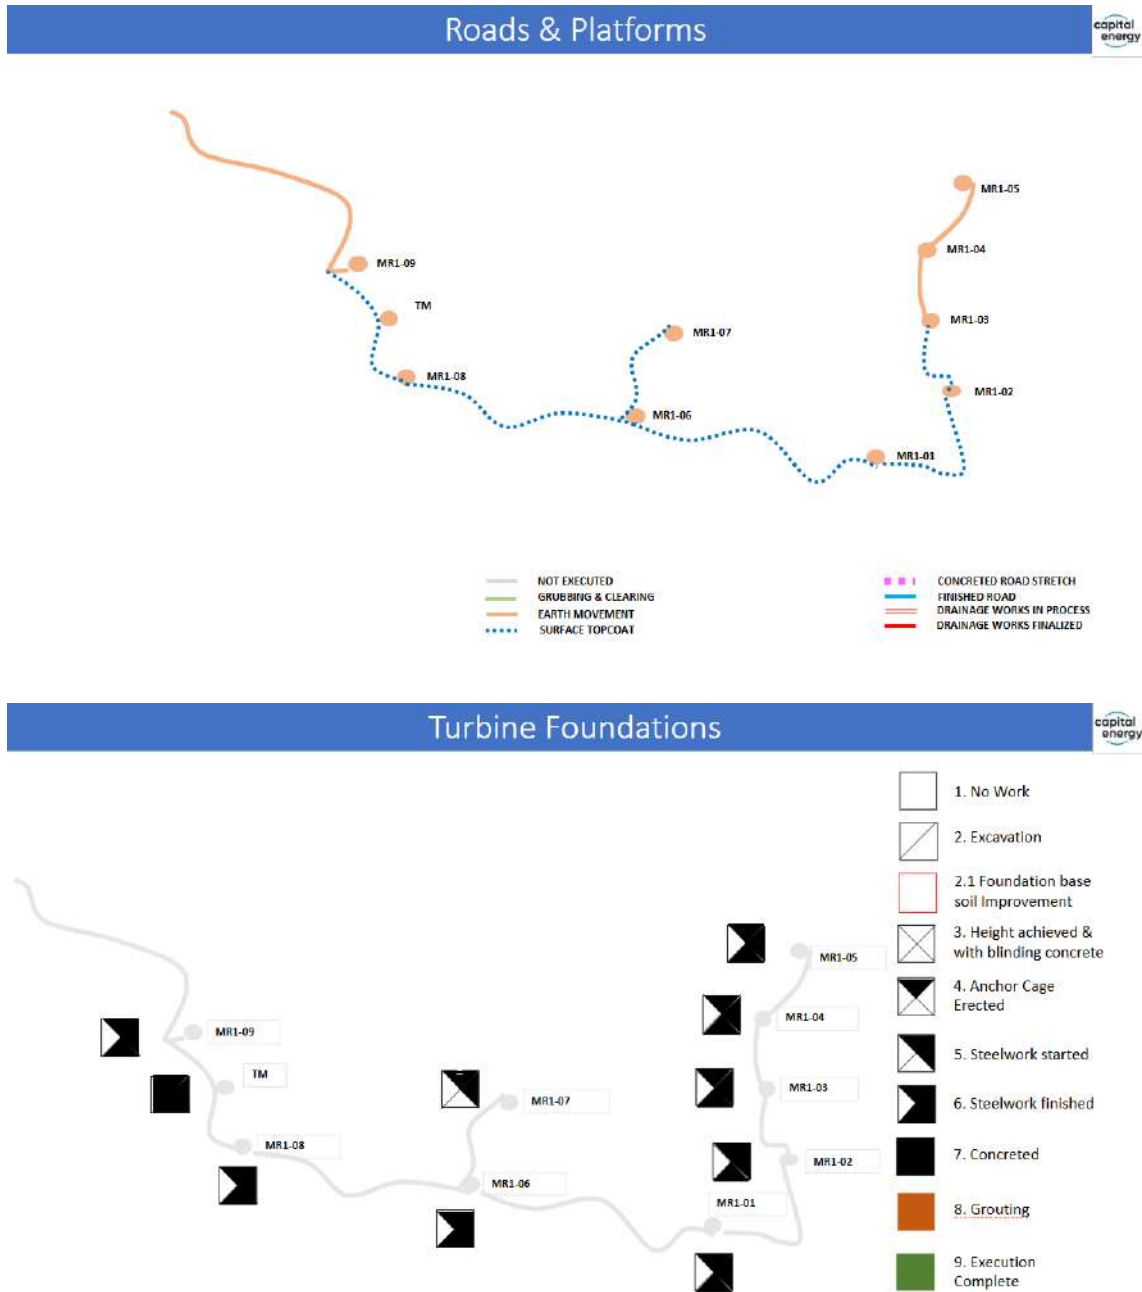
Estado y plano de obras ejecutadas a fin de mes.
